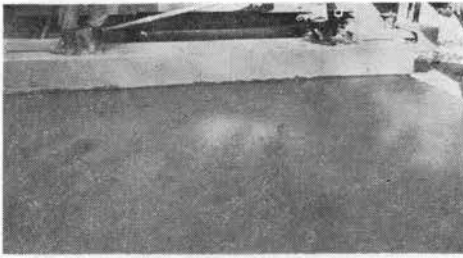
仕上げ機で仕上げられた平滑なコンクリート面
